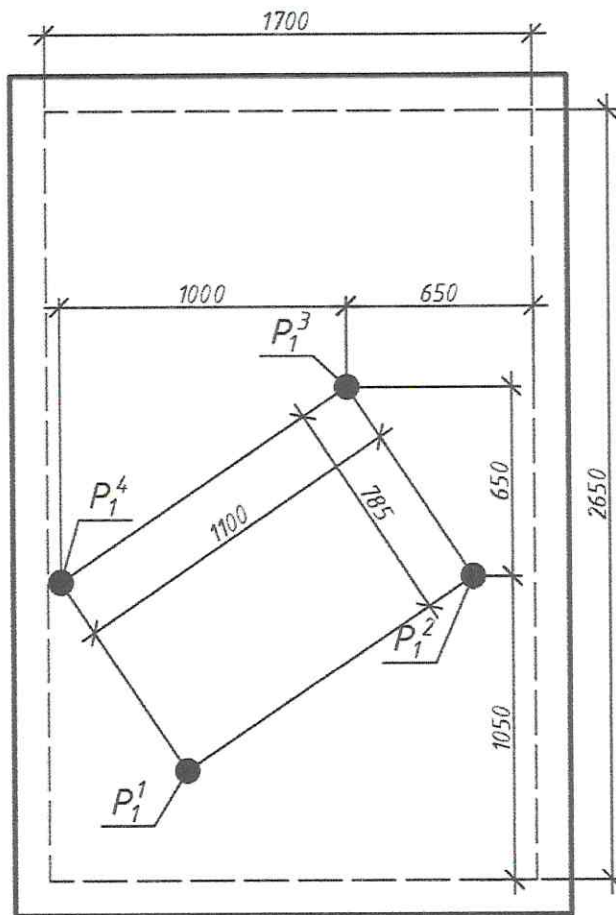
Нагрузки на плиту перекрытия шахты от лифтового оборудования.
